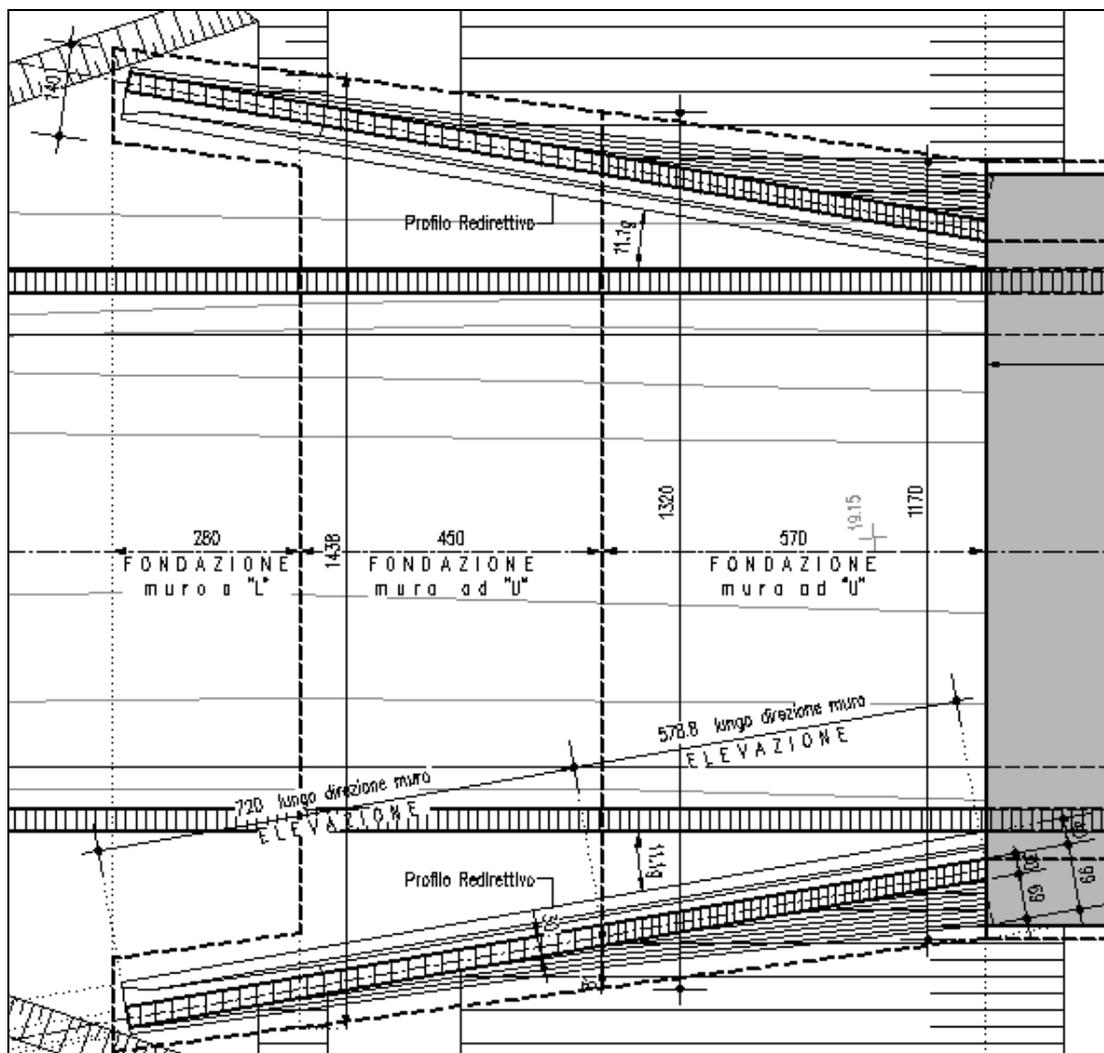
PARTICOLARE ALLARGAMENTO PLANIMETRICO DELLE ELEVAZIONI
